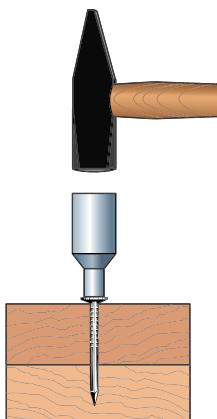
Углубление шляпки гвоздя с помощью цилиндрического устройства
